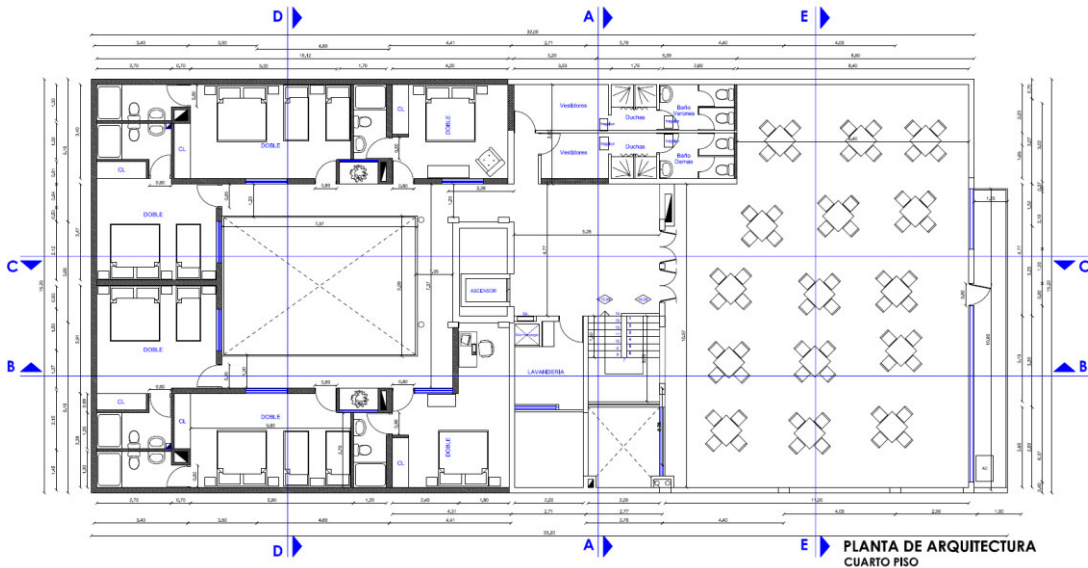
Planta arquitectónica del Cuarto piso: 400,17 m2
